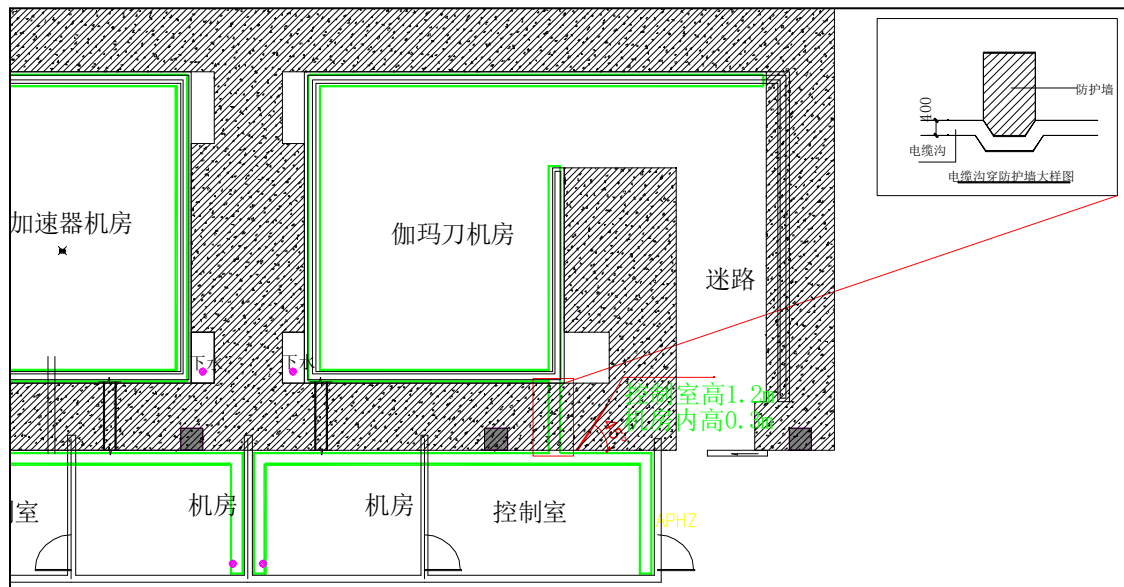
伽玛刀机房电缆穿墙管道布置示意图
